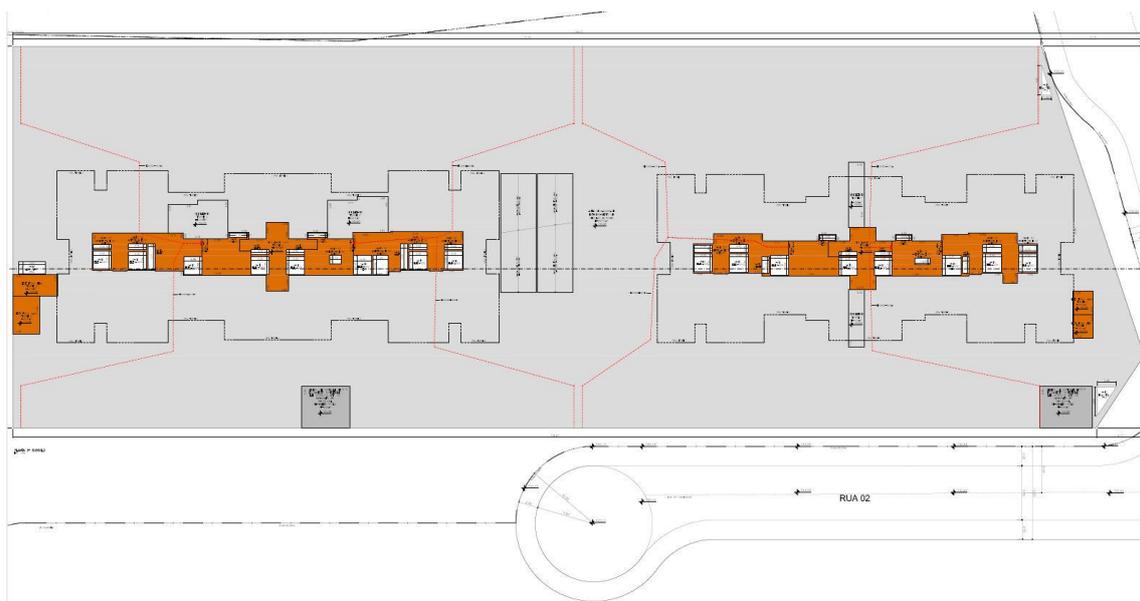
Planta do 2º Subsolo torres 1 e 2 do setor B1.
